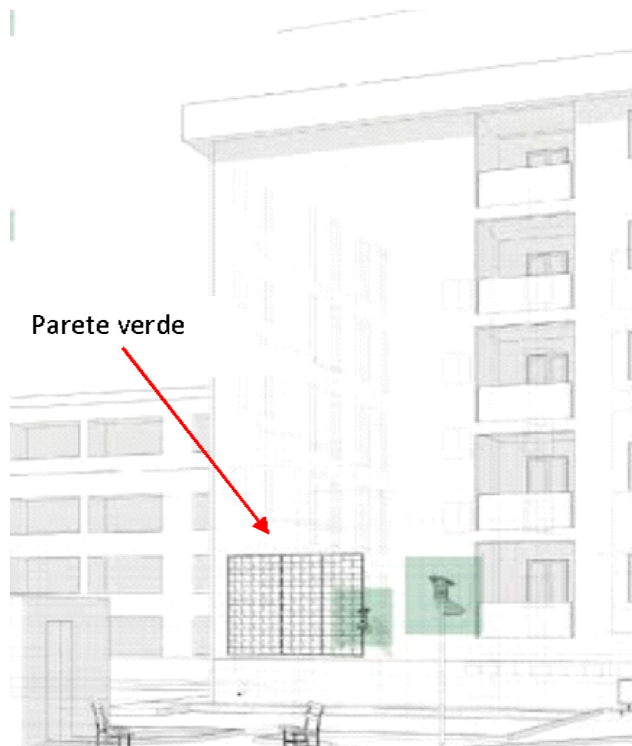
Dettaglio del posizionamento della parete verde (Vadini et al., 2025).
